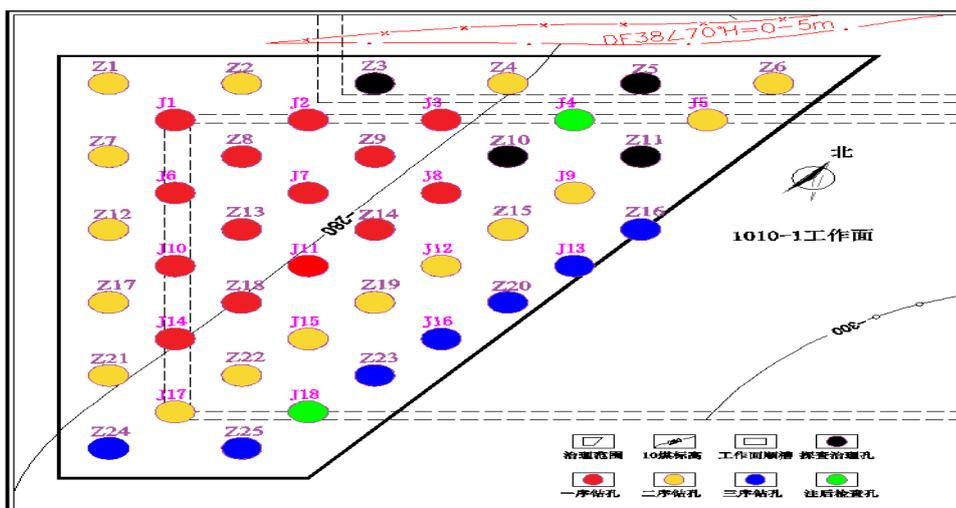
1010-1 工作面“四含”注浆改造范围及钻孔布置平面图
